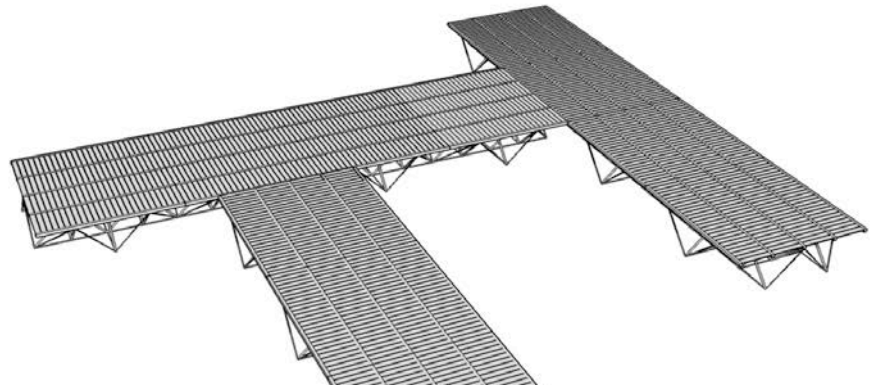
Exemples d'applications visées (accessibilité, plateforme temporaire)
